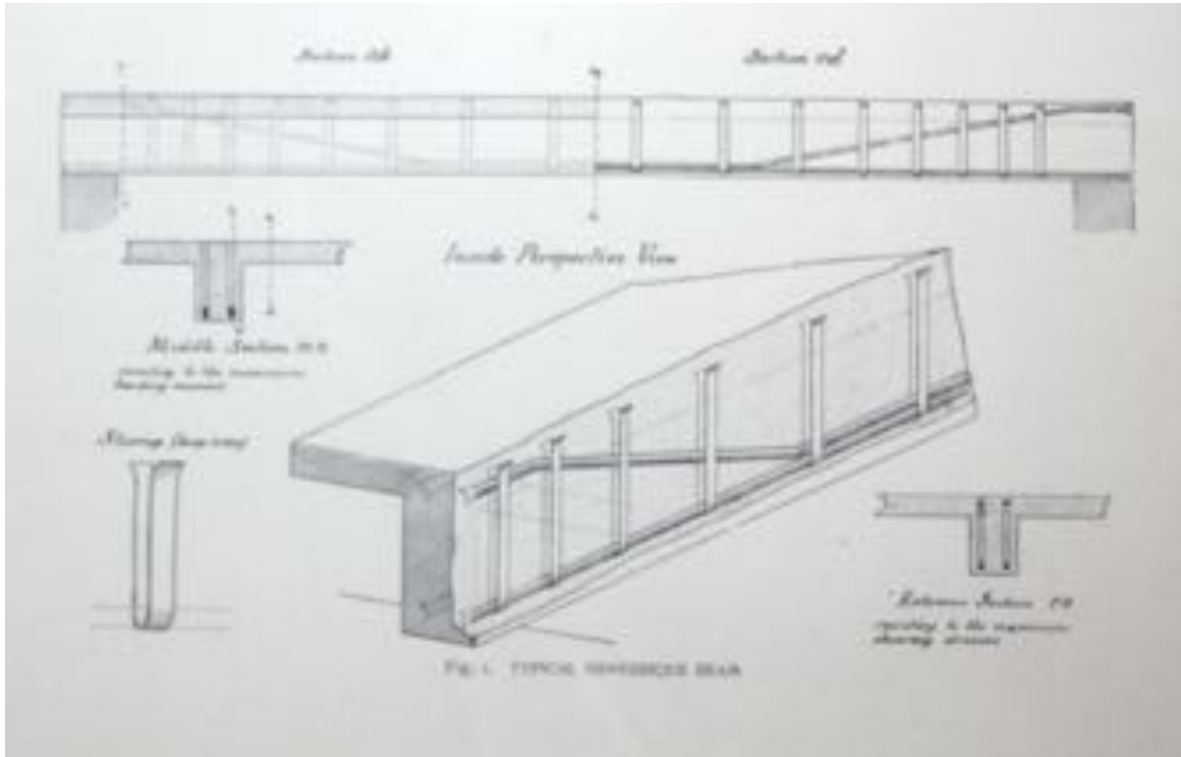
La imagen característica de la propaganda del *Béton armé système Hennebique* que muestra como integraba entre la viga y la losa refuerzos de acero, denominados estribos, que unían las barras empotradas en los muros y en las losas del techo, formando montantes y resolviendo la trama estructural para crear edificios monolíticos.
